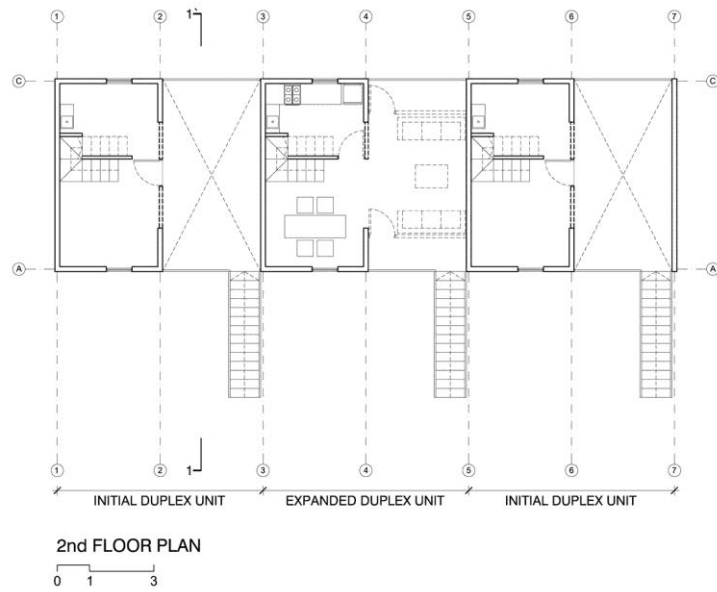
Planta Arquitectónica, Proyecto ELEMENTAL. Fuente: (Delaqua, 2010).
